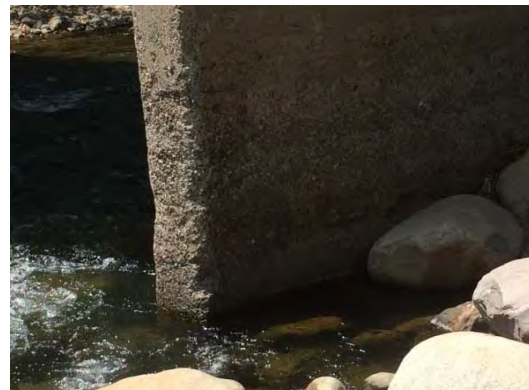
Puente Taujica Las paredes delgadas de los pilares se encuentran con daños por las rocas entre otros que fluyen en la corriente rápida.
